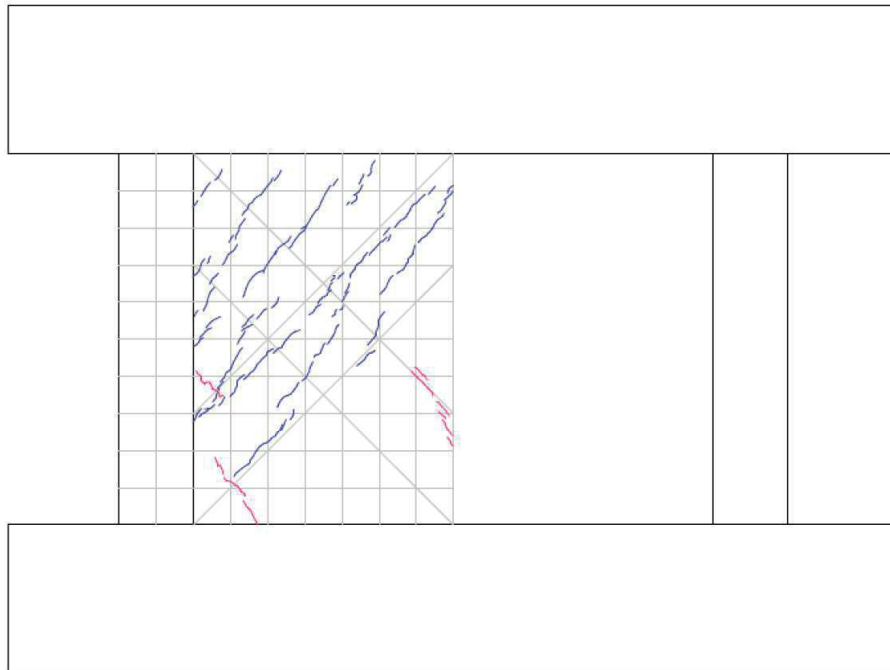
試験体 S-13-D I 事前加力終了時 (0.75/1000rad.) ひび割れ図
